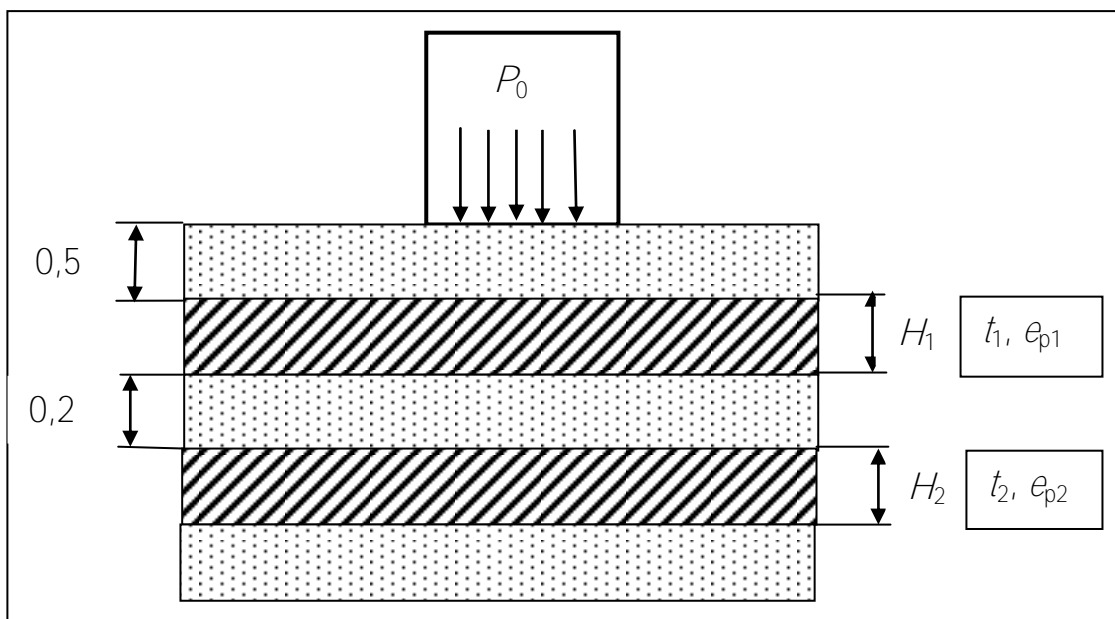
Расчетная схема для определения полной стабилизации осадки фундамента
